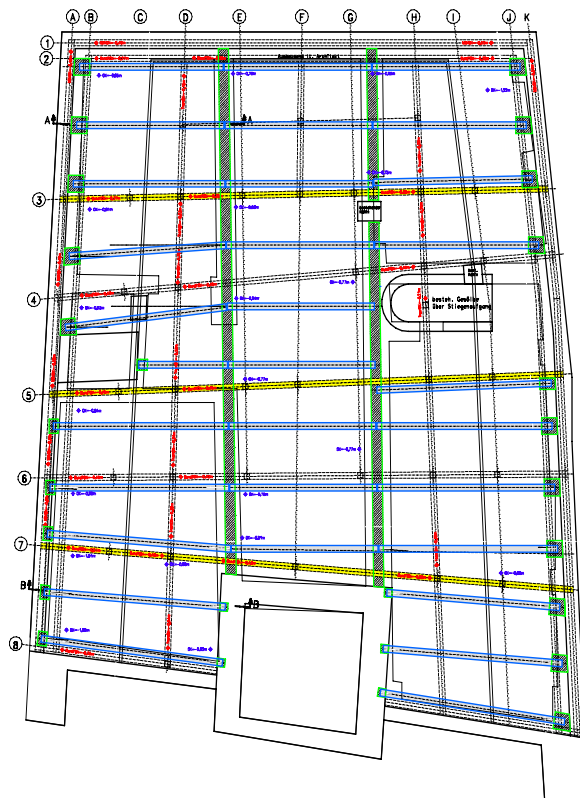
Grundriss mit Lage der Vollgespärre (gelb) und der Deckenbalken (blau-grau)
